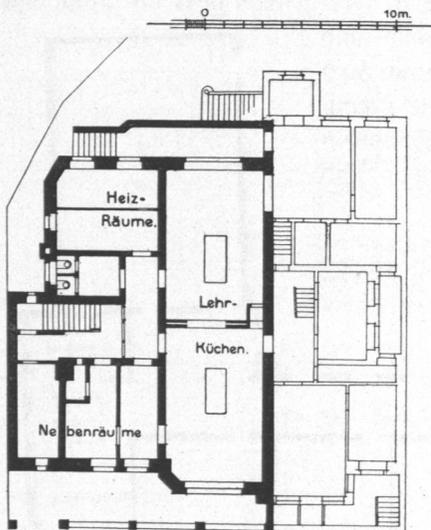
Haushaltungsschule Wallstraße, Kellergrundriß.
